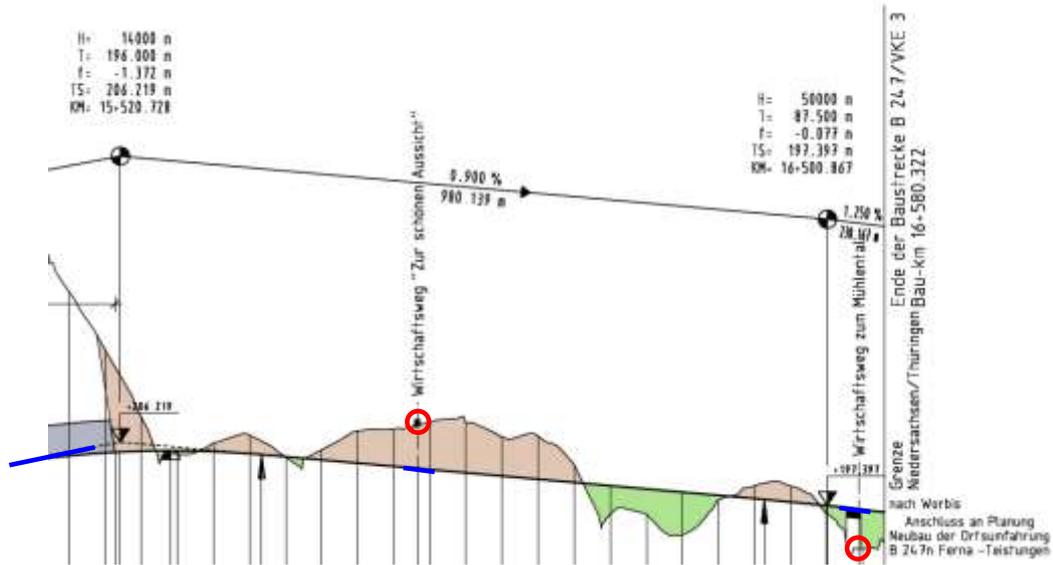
Zwangspunkte Höhenplan südl. Tunnel
